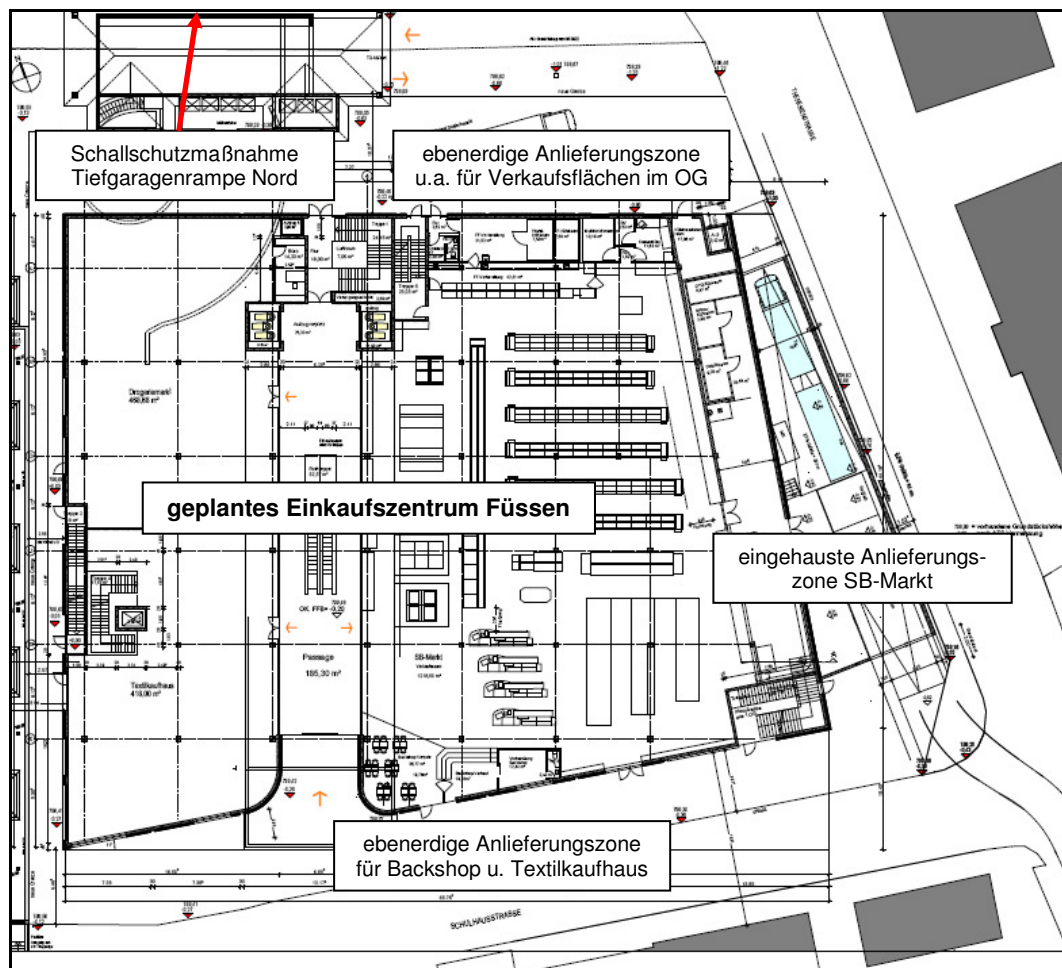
Grundriss-Skizze des geplanten Einkaufszentrums mit Darstellung der Anlieferungs-Zonen sowie Ein-/Ausfahrt zur Tiefgarage
